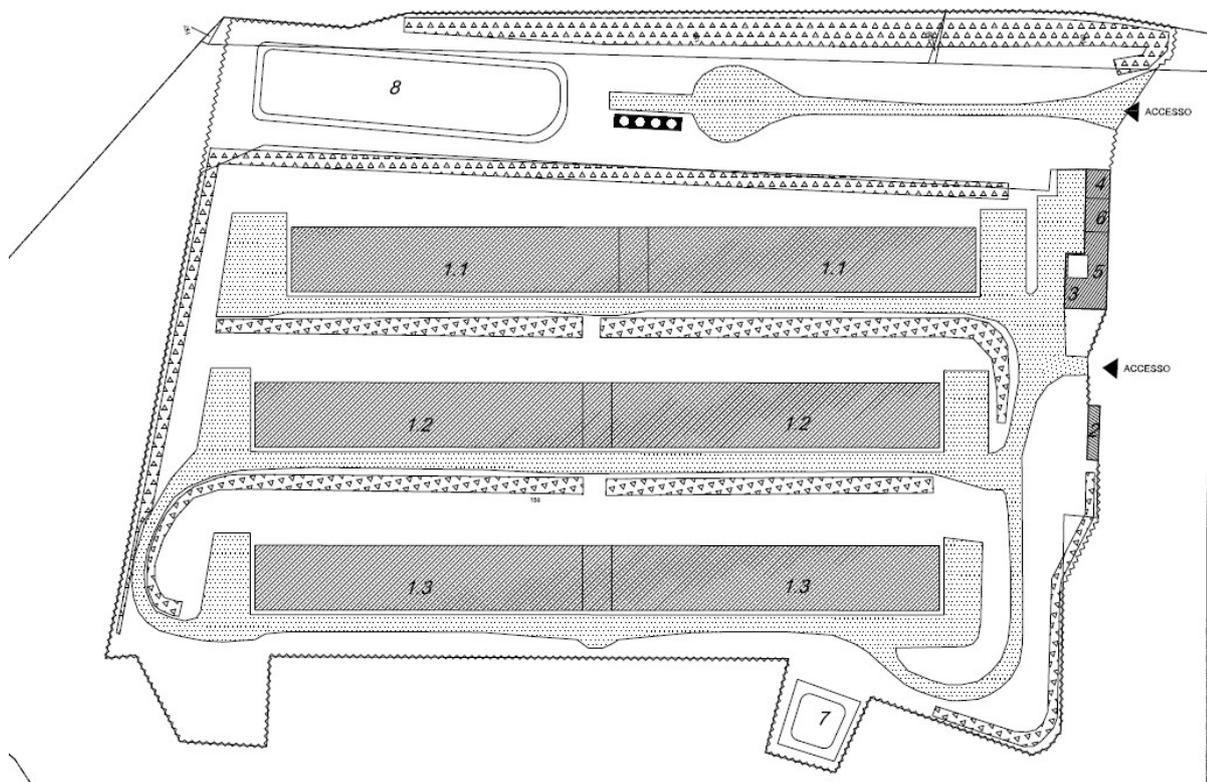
Planimetria dell'allevamento avicolo Catignano
